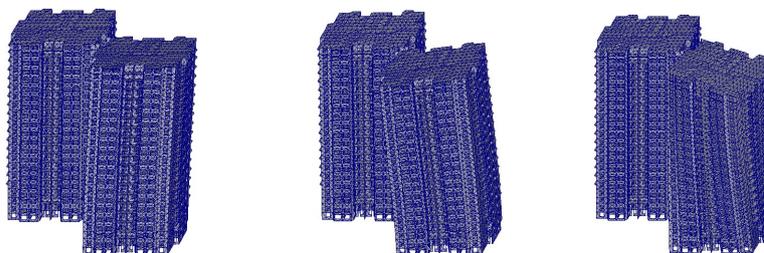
1, 2 и 3 формы колебаний для здания с монолитными наружными продольными стенами
